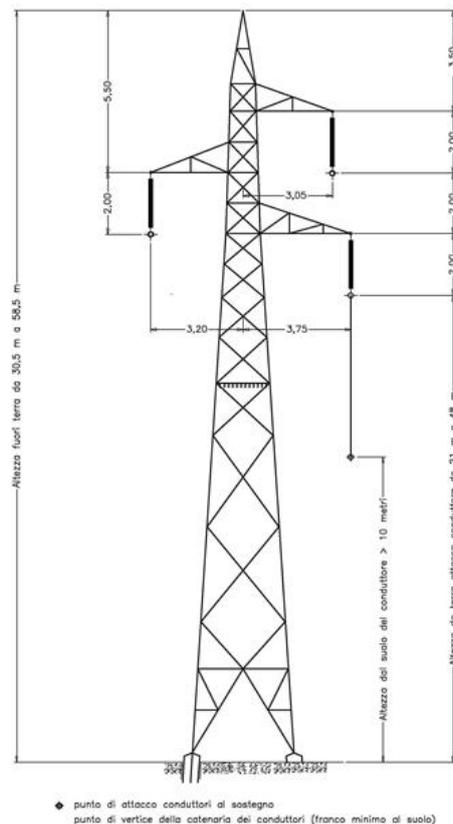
Schema tipico sostegno a traliccio (arm. Sospensione)
